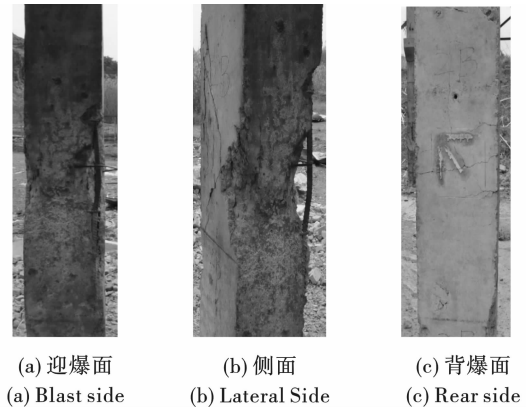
球形装药爆炸作用下钢筋混凝土柱的毁伤程度
